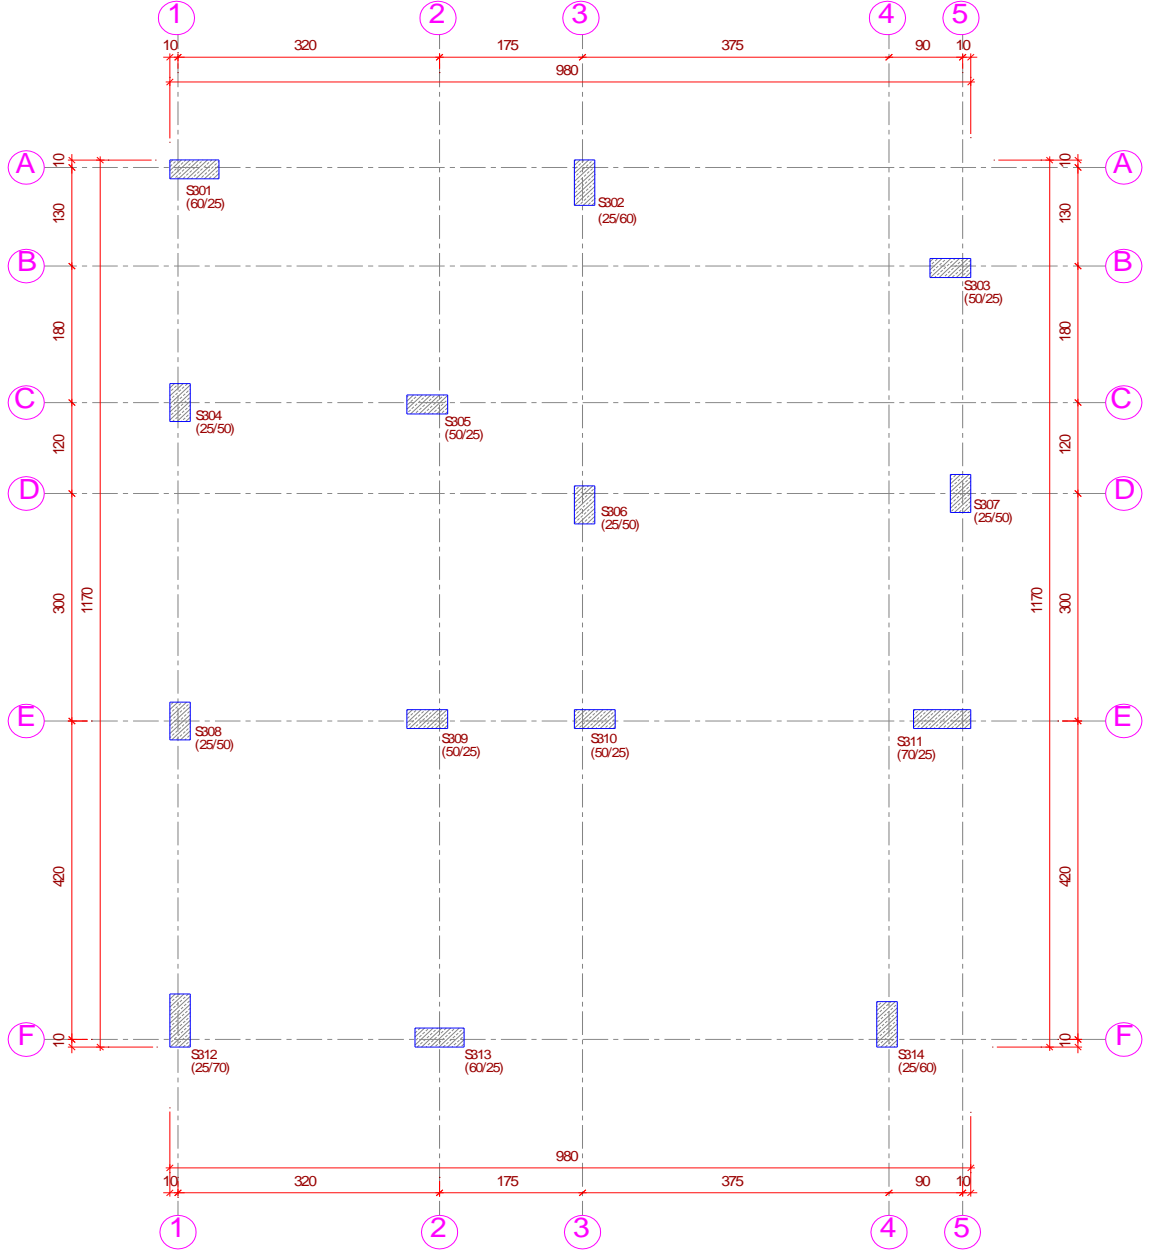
Kolon aplikasyon planı iç ölçülendirmesi
